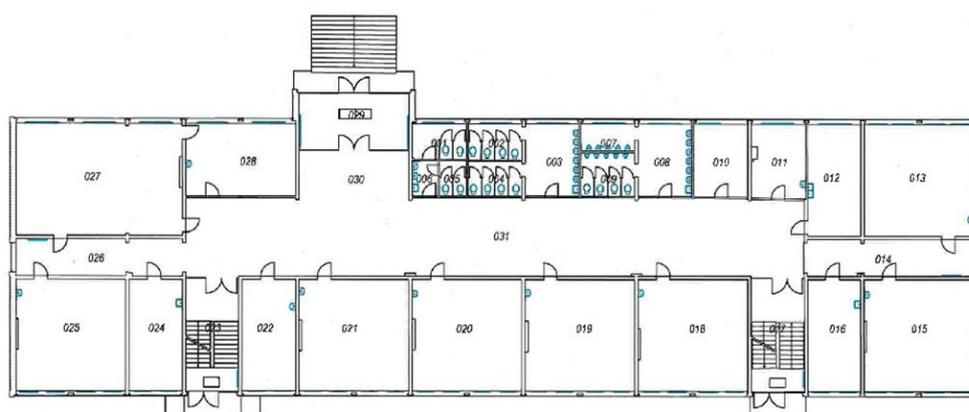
Grundriss des Schulgebäudes Typ „Dresden R 81“, Erdgeschoss (Foto: Stadt Dresden)
